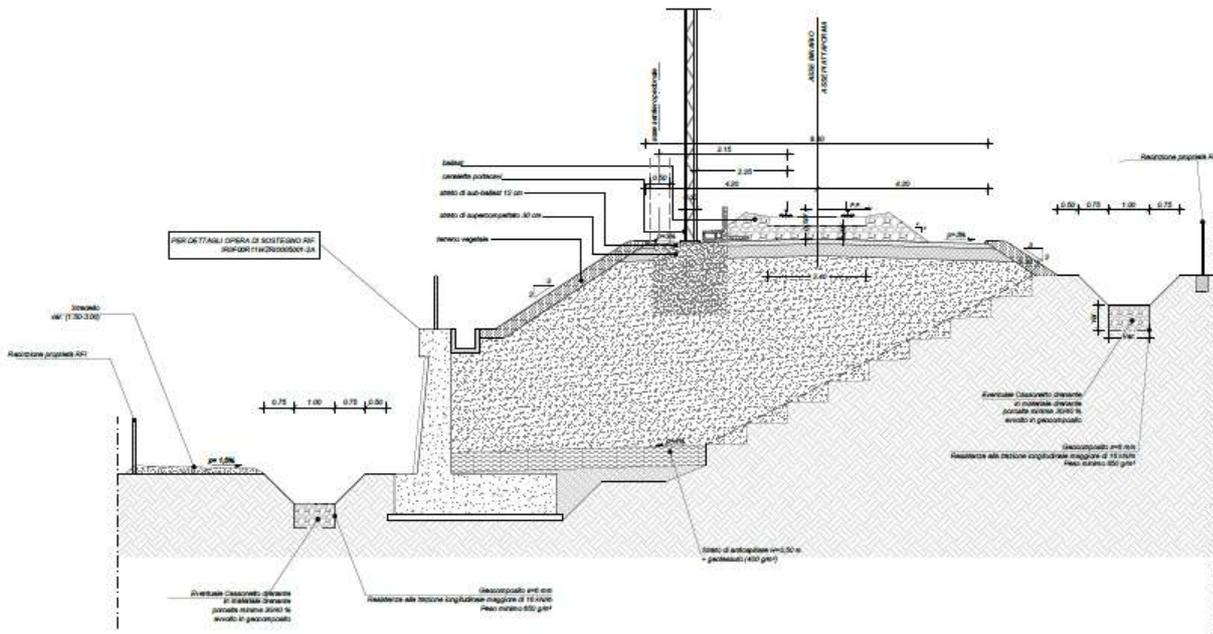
Sezione tipo ferroviaria in rilevato a singolo binario in rettilineo con opera di sostegno
